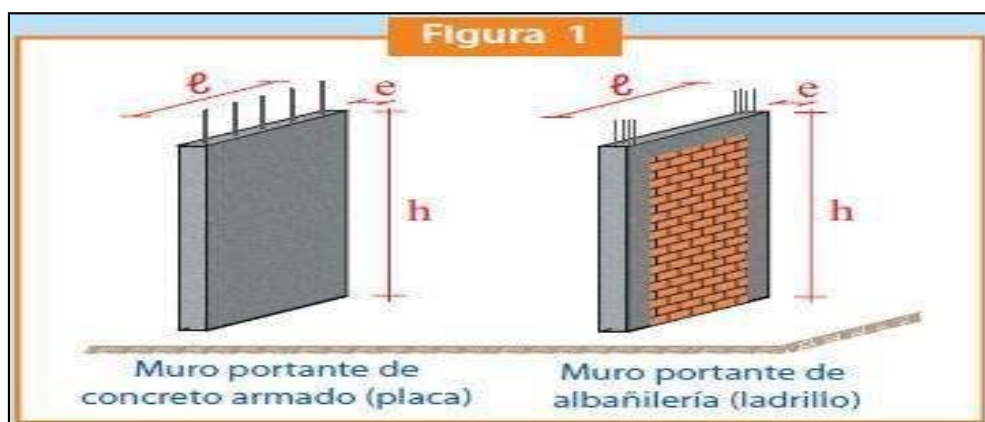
Ilustración de muro portante de concreto armado y albañilería Confinada.
